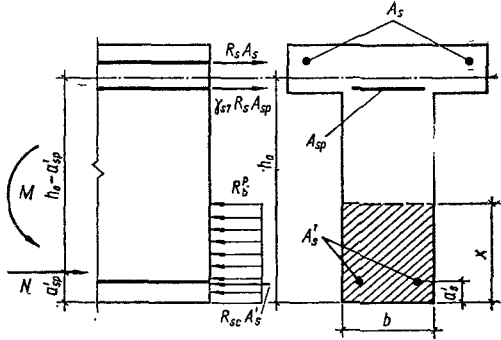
Схема усилий в поперечном сечении внецентренно-обжатого железобетонного элемента с прямоугольной сжатой зоной:
